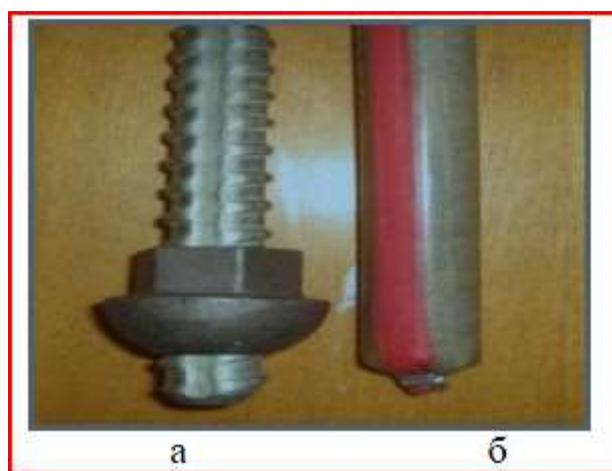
Сталеполимерный анкер (а), полимерный наполнитель (б)
